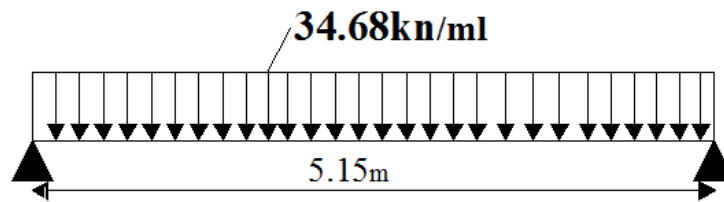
schéma présentatif de la poutre palier au L'ELU
